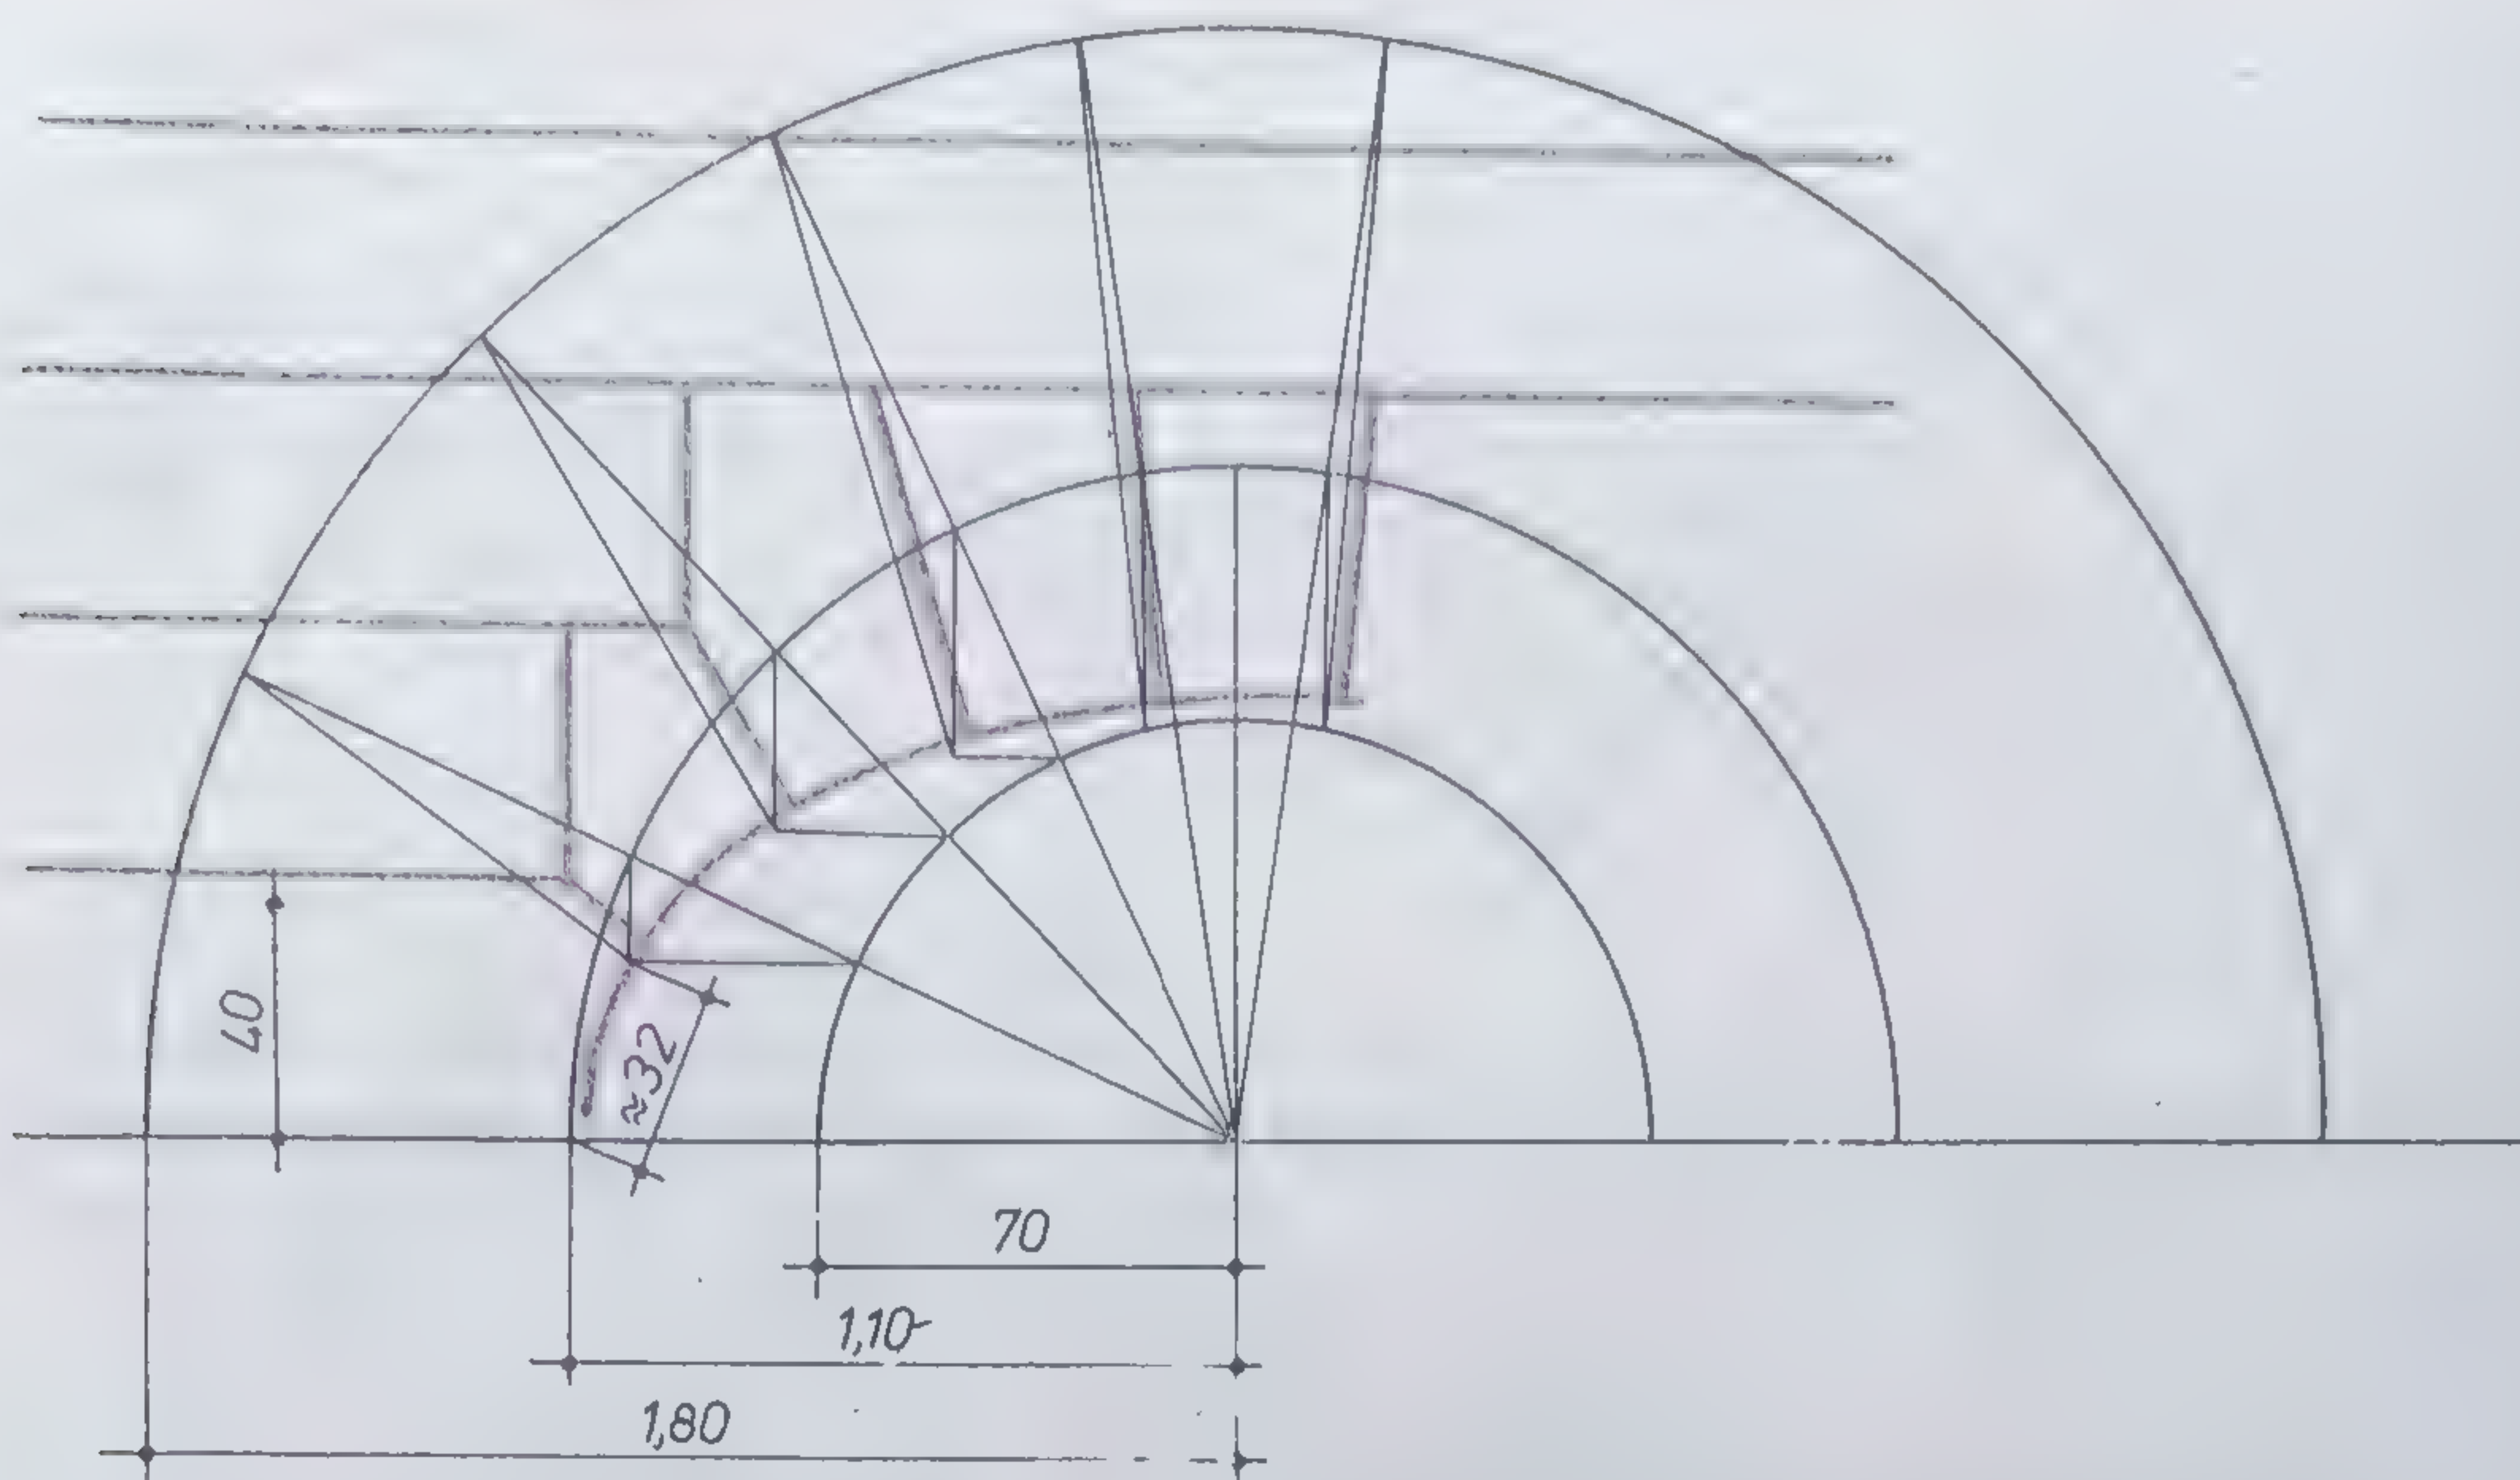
Construcția aparențului unei bolți eliptice.
